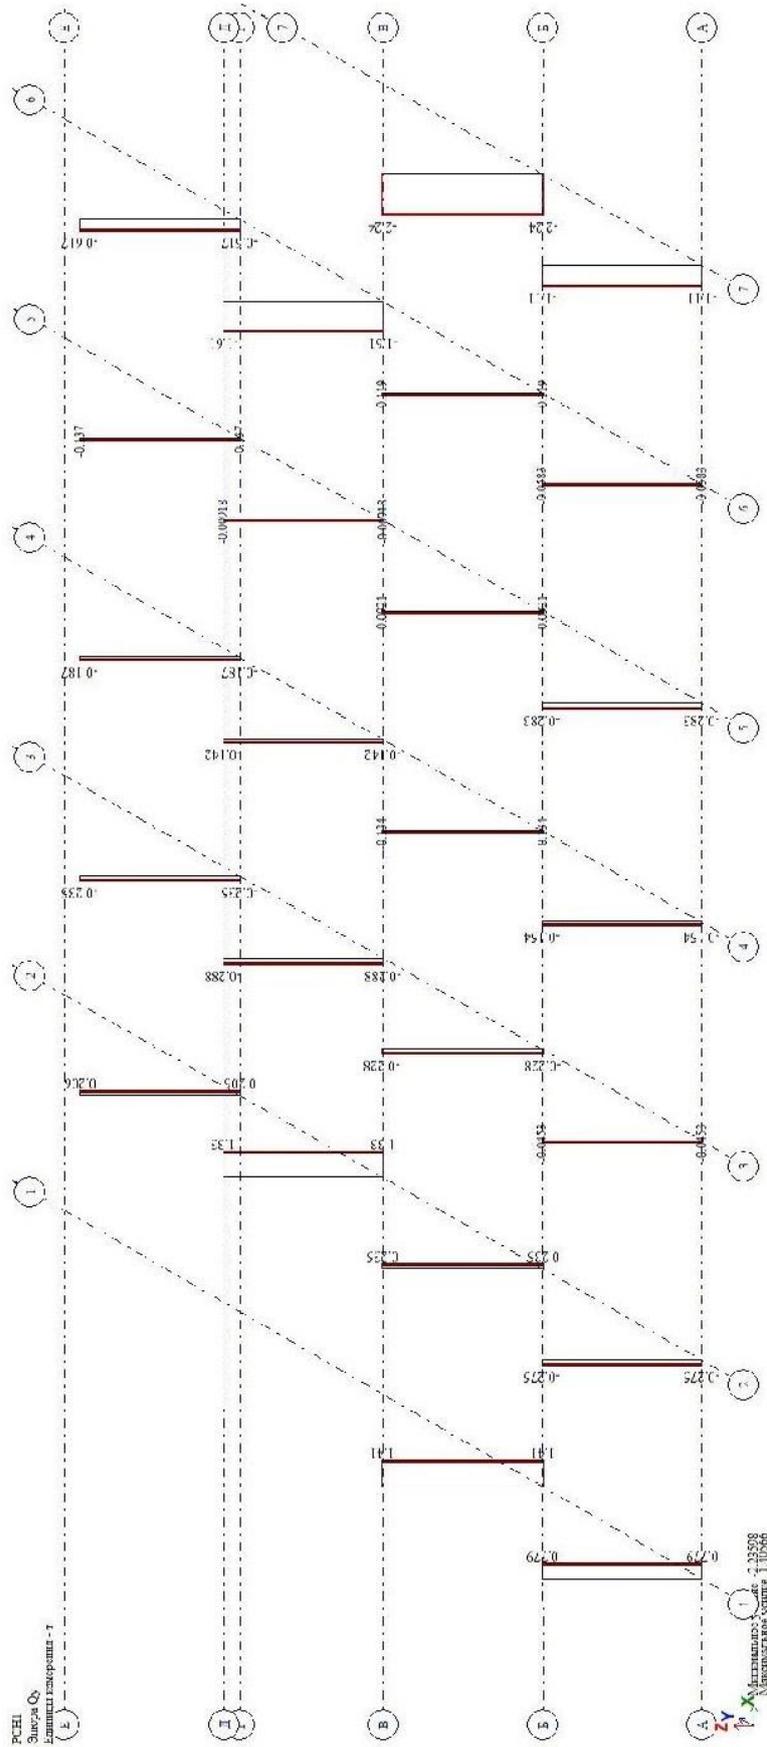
Схема нагрузок  $Q_y$  на фундаменты АБК
